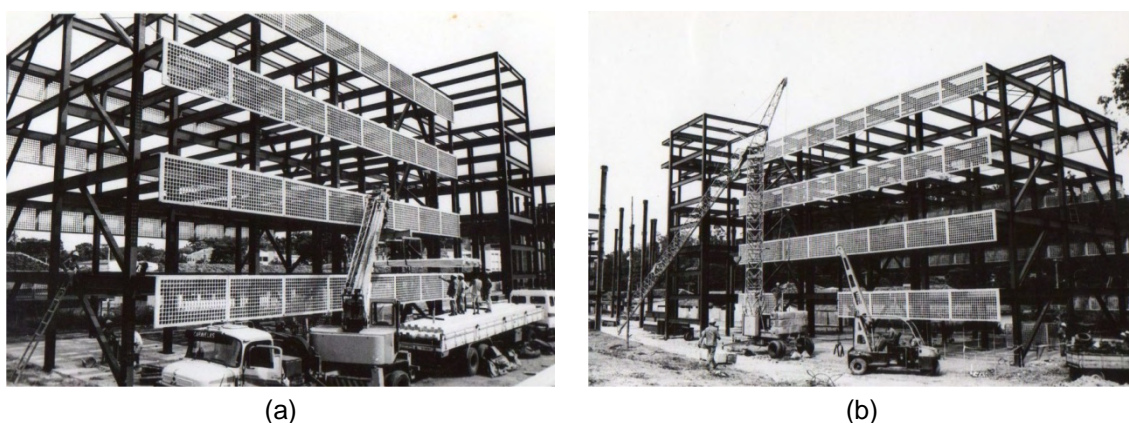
Fixação dos *brises soleils* das fachadas na etapa de construção.
